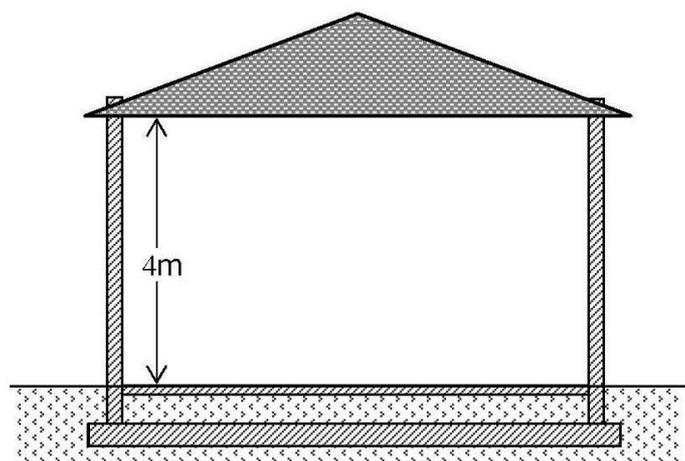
Exemple d'un bâtiment de type 3 : ERP
